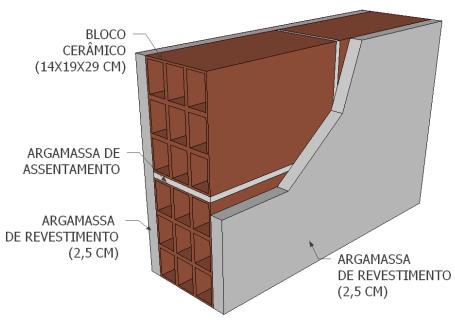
Esquema do elemento construtivo, objeto dessa FAD
